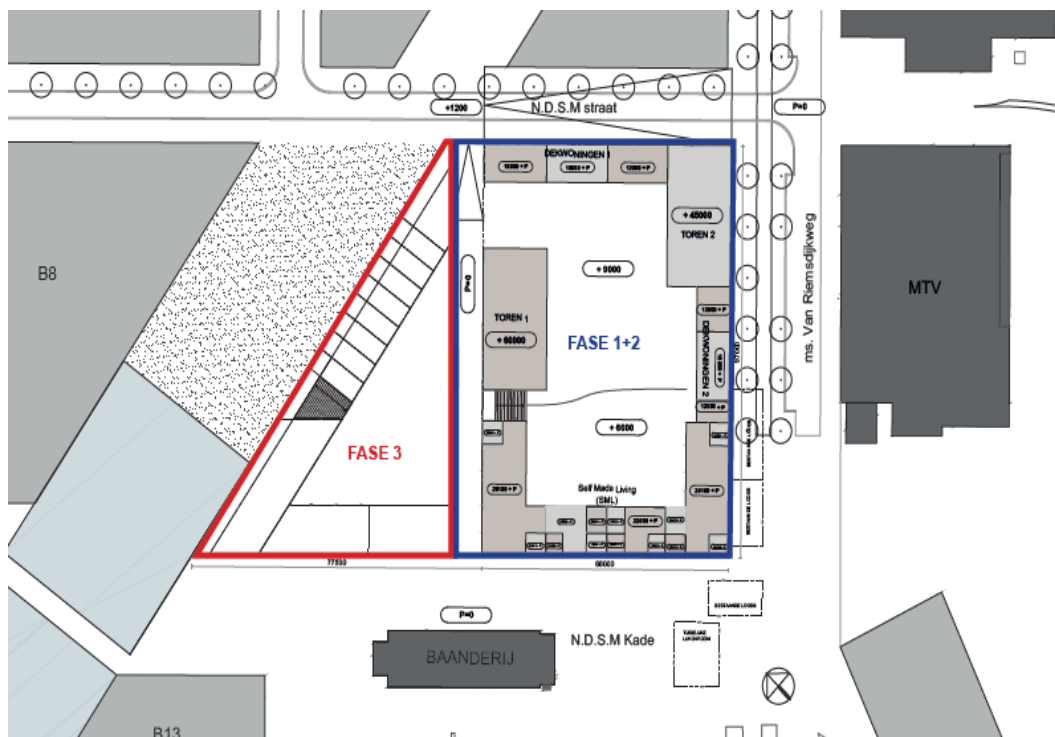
ligging uit te werken bestemming binnen plangebied NDSM-werf West
